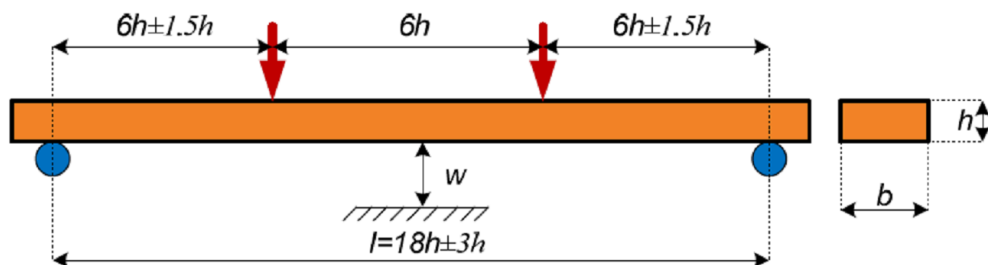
l'essai de flexion à 4 points sur les poutrelles en béton [11].
